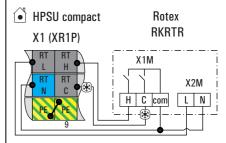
Collegamento con termostato ambientale collegato via radio
